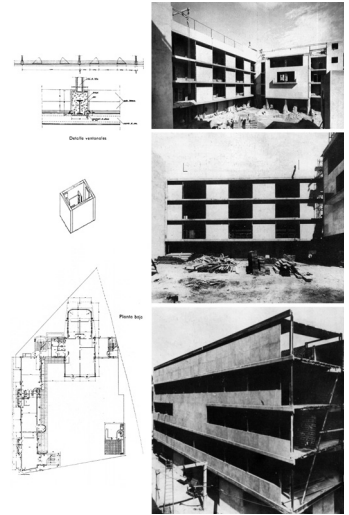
José Luis Sert, Josep Torres Clavé, Juan Bautista Subirana, Dispensario Central Antituberculoso de Barcelona, DCAT, 1933-1937. Izquierda: detalles constructivos de la fachada y planta baja; derecha: distintas fases de la construcción, en “Dispensario antituberculoso de la calle Torres Amat (1934-38): Arquitectos: J. Luis Sert, J. Torres Clavé, Juan Bta. Subirana”, *Cuadernos de Arquitectura*, 1960, n. 40, pp. 6-11.
